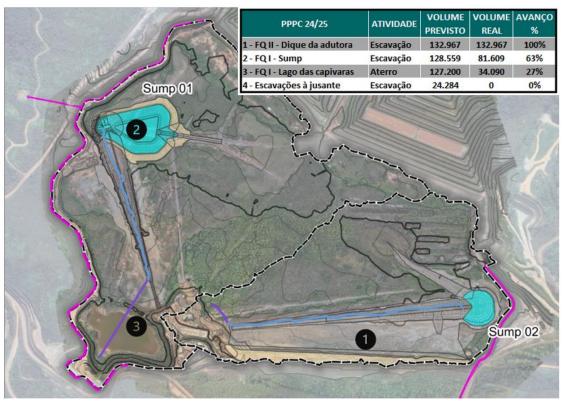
Planta geral do teste piloto e plano de chuvas de Forquilha II – Implantação concluída (Outubro/24).
